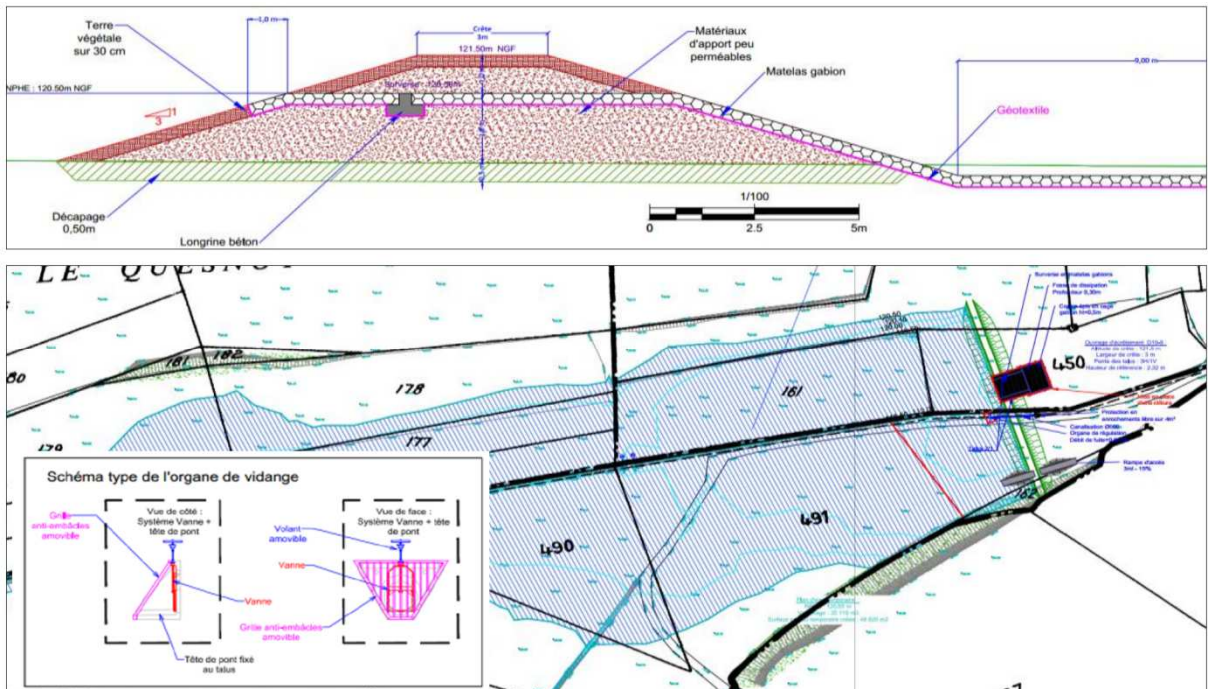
Extrait du plan de masse – Ouvrage D19-8
